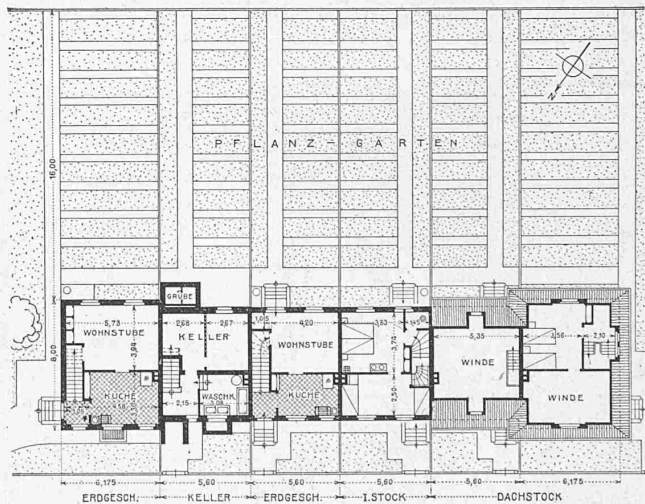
Grundrisse einer Sechshäusergruppe. — Masstab 1:400.
